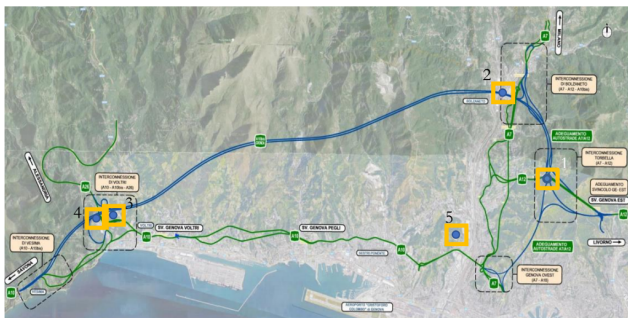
Planimetria della cantierizzazione del Lotto "Zero".
